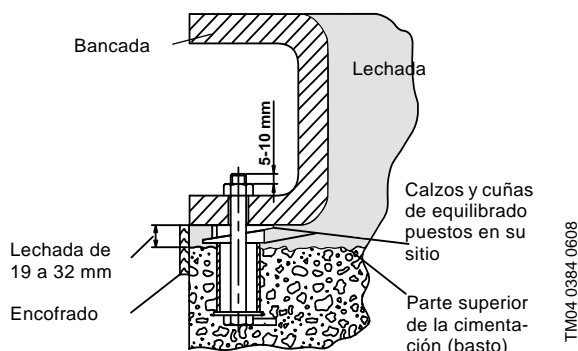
Vista seccional de la cimentación con los pernos de cimentación, lechada y bancada
